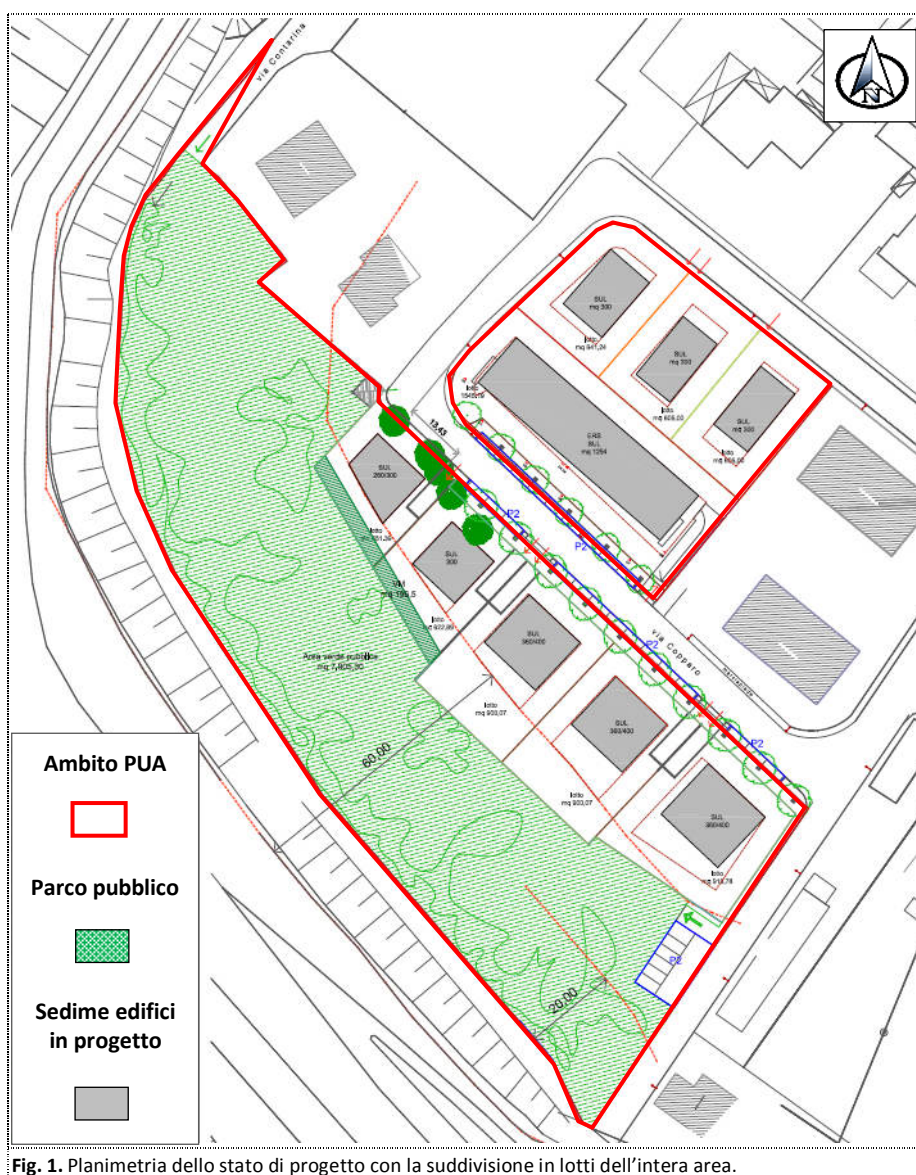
Planimetria dello stato di progetto con la suddivisione in lotti dell'intera area.
